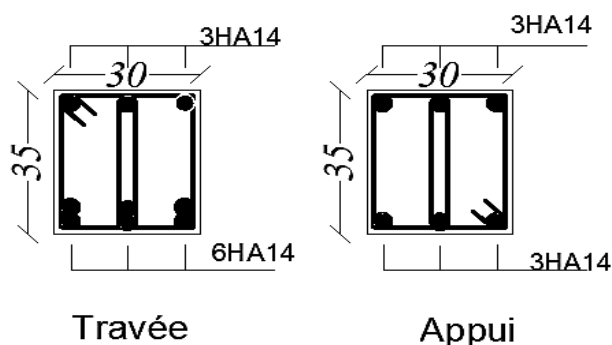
Schéma de ferrailage de poutre palière en béton ordinaire.
